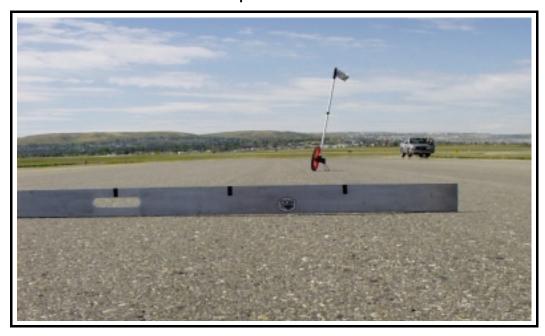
Très faible dépression le long d'un joint longitudinal et problèmes mineurs de déchaussement et de désintégration dans la section d'essai de liant classé selon le rendement- Septembre 2000
